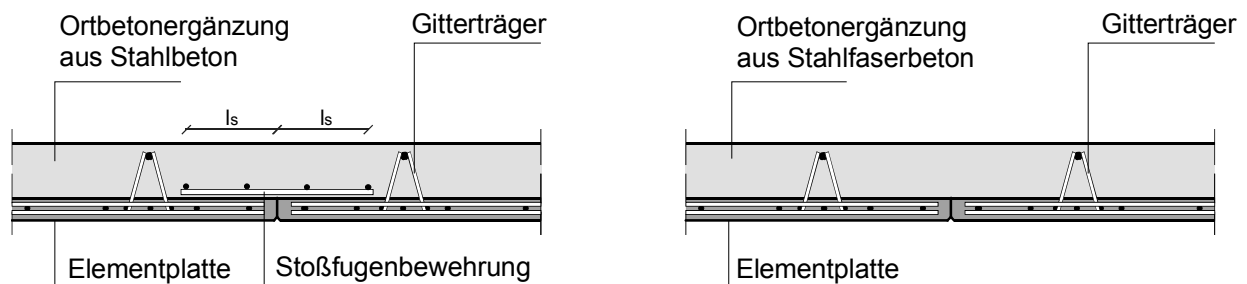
Decke aus Elementplatten mit Stahlfaserortbetonergänzung (EMSO)
